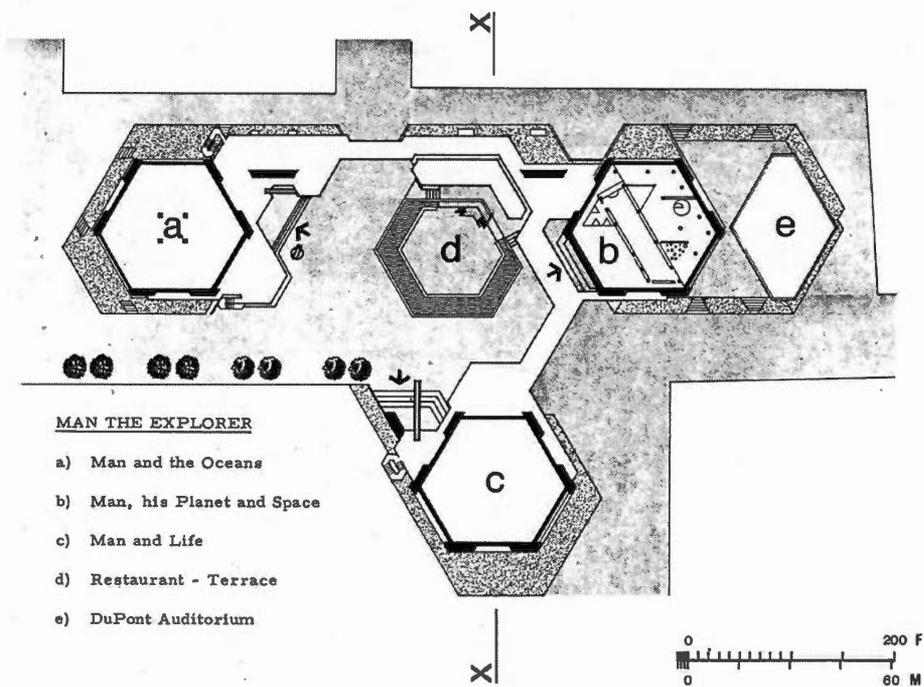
Plan de site. Pavillon thématique L'Homme interroge l'univers
